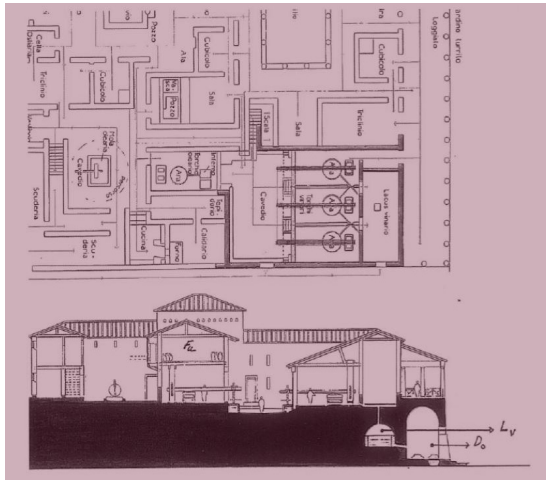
Planta y sección este-oeste de la villa romana "Settefinestre" (Roma). (Fuente: Yravedra,2000).
